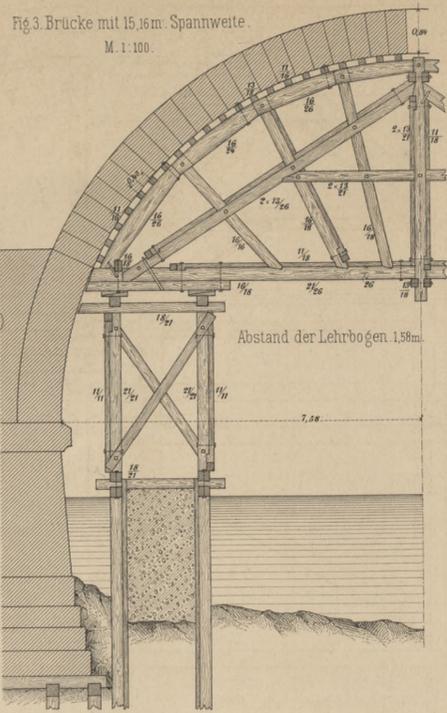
Brücke mit 15,16m Spannweite. M. 1:100.
